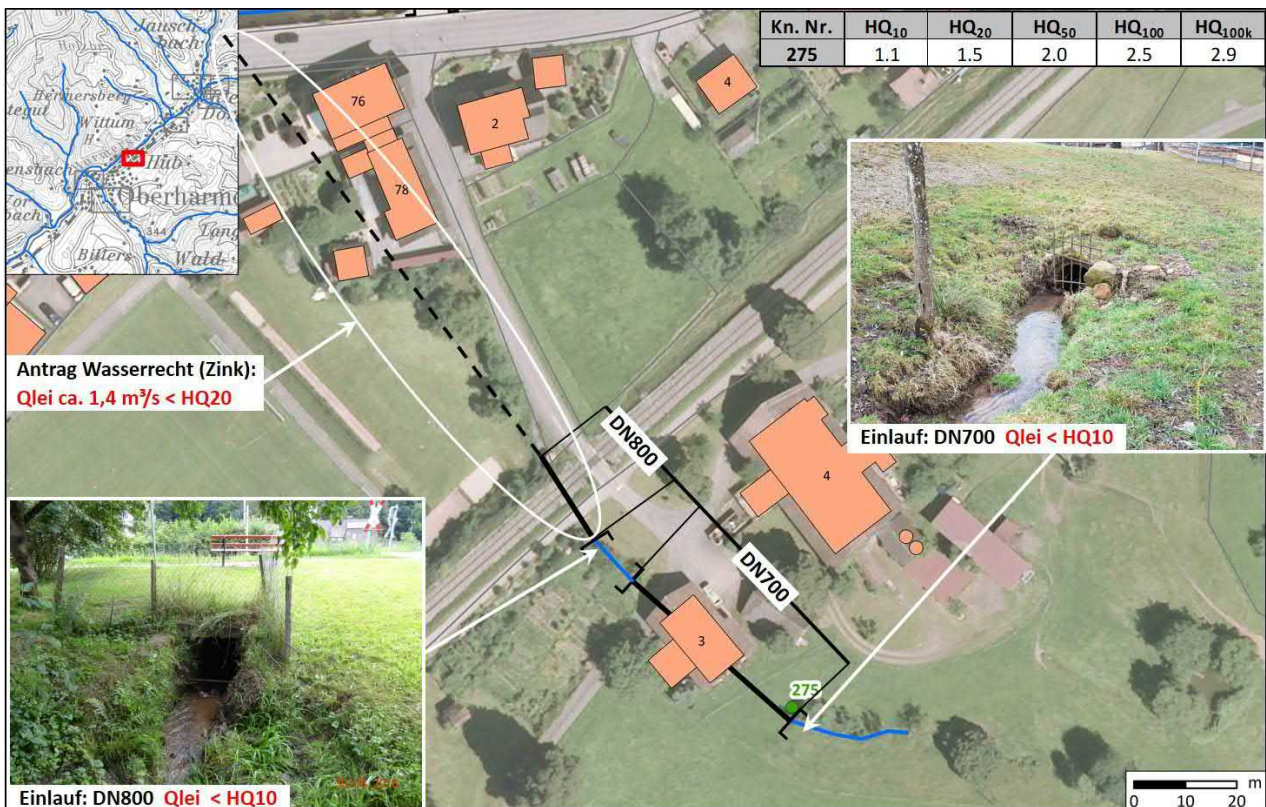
Außenbereich Hubbächlein- Lageplan und Auswertung der hydraulischen Berechnungen
